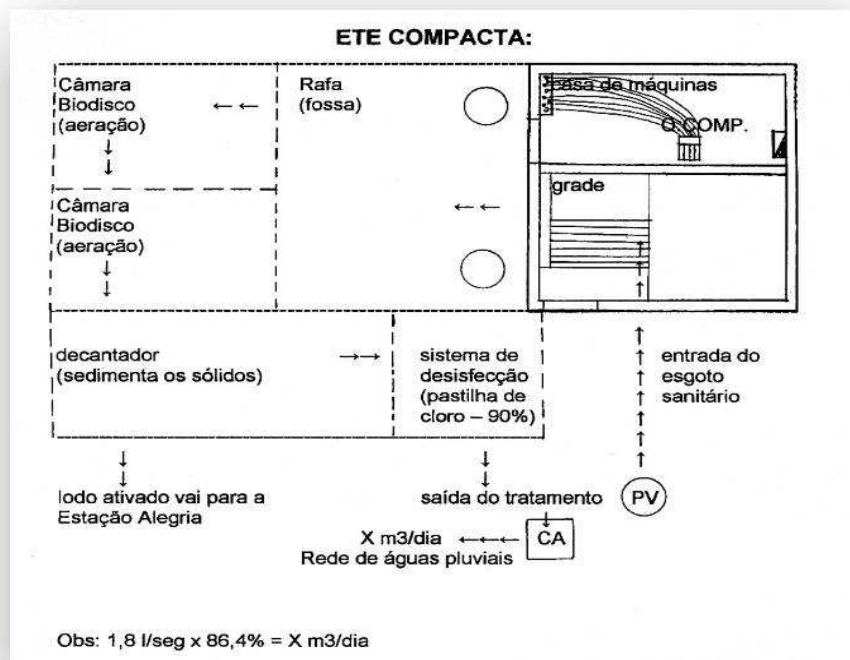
Planta baixa da ETE: esquema da Estação de Tratamento de Esgoto do HECC
